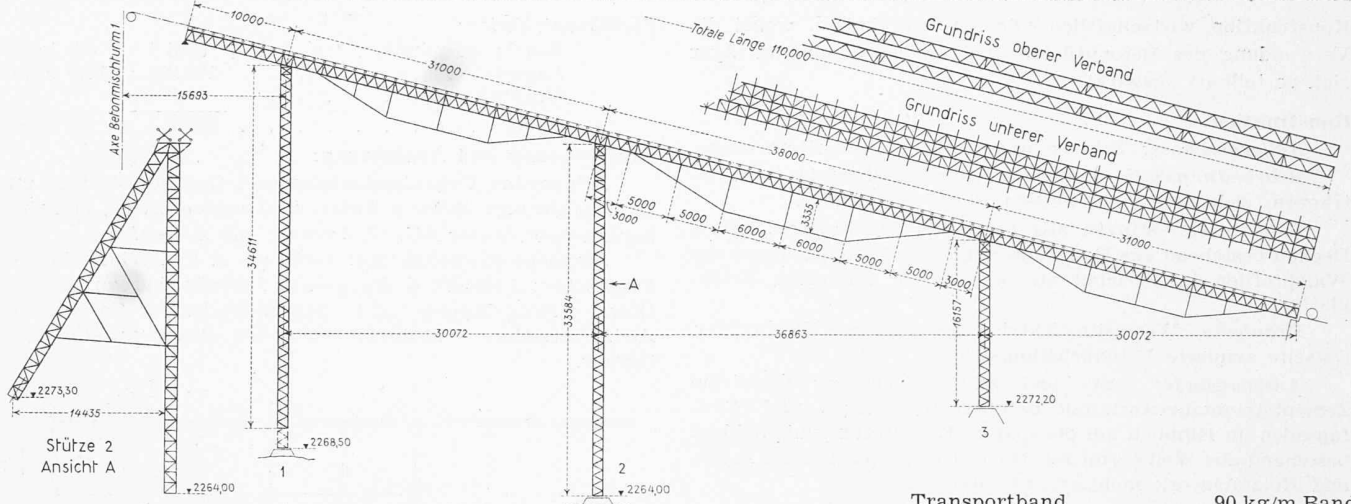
Transportbrücke Baustelle Oberaar, Übersicht 1 : 700
